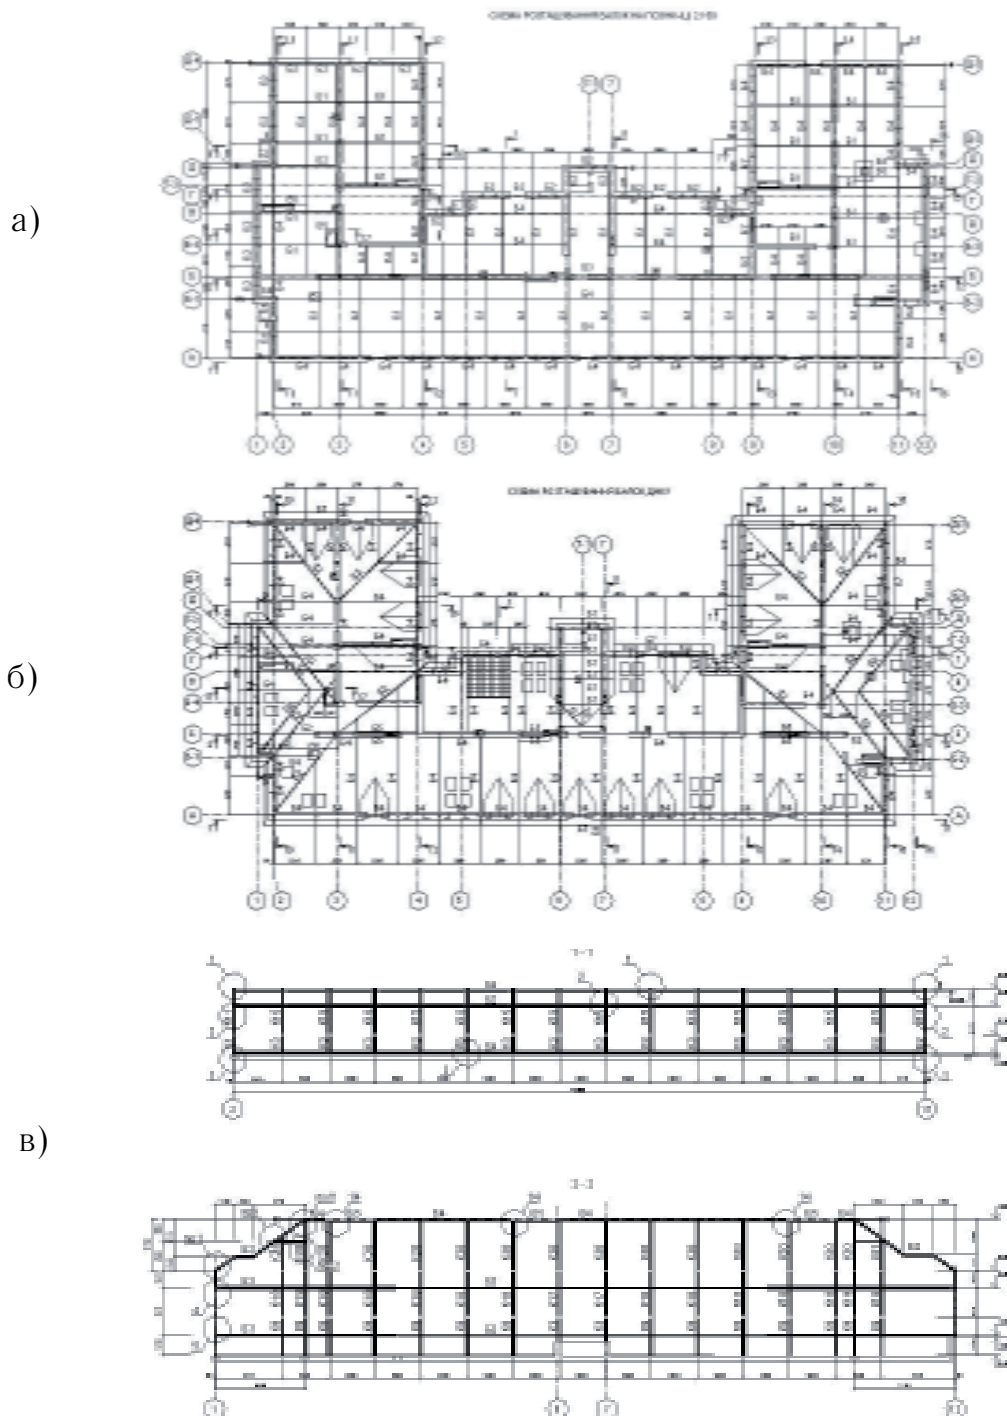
Схеми розташування балок перекриття (а), даху (б) та перерізи 1-1, 2-2 (в)
